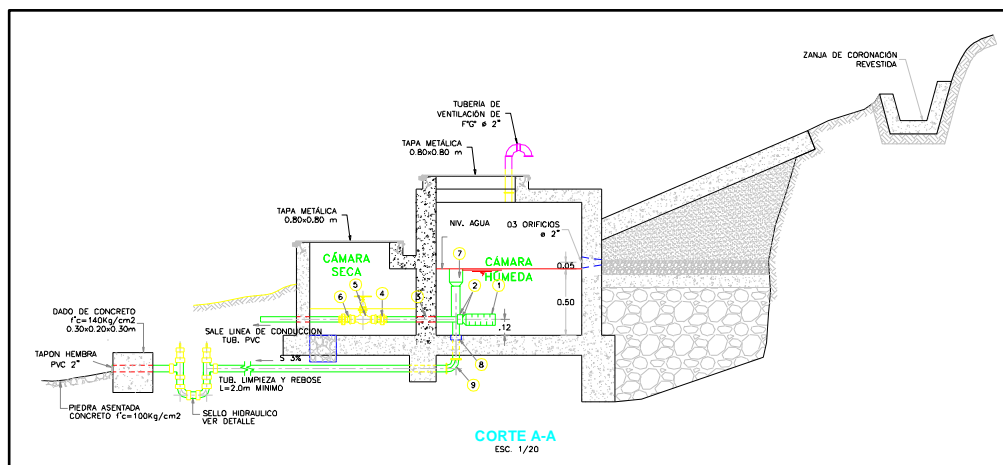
Vista de Elevación de la Captación Tipo Manantial de Ladera Projectada
